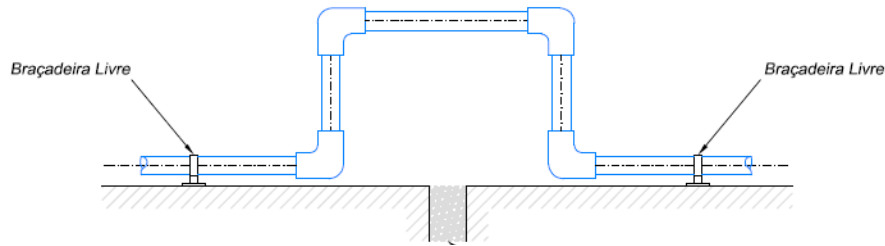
Atravessamento de juntas de dilatação e elementos estruturais (18)
